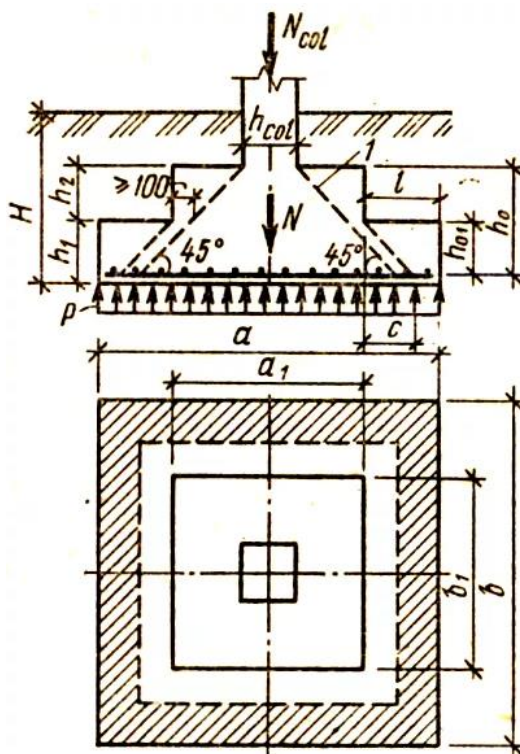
Расчетная схема фундамента колонны на продавливание.
